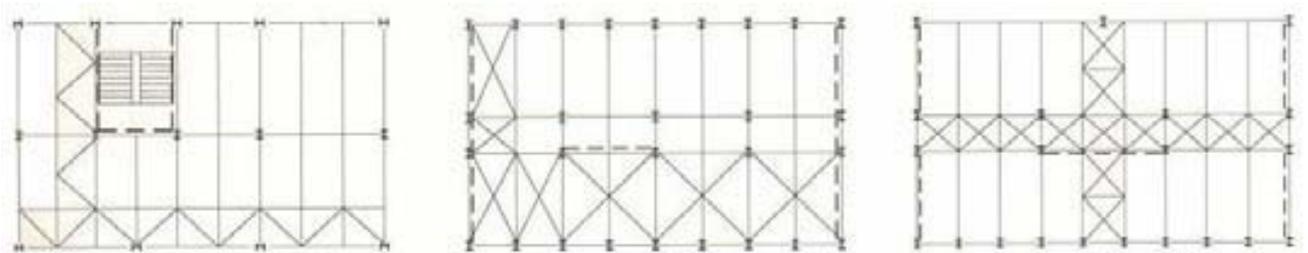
Esquema de contraventamentos horizontais para edifícios baixos
